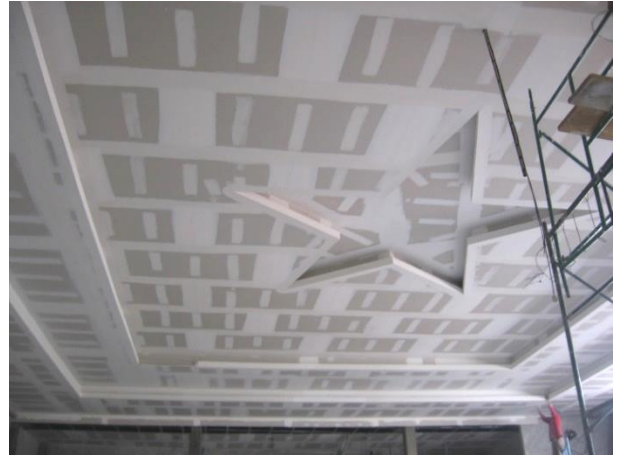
y 22. Proceso de obra, fabricación de plafones salón principal. Autoría propia
